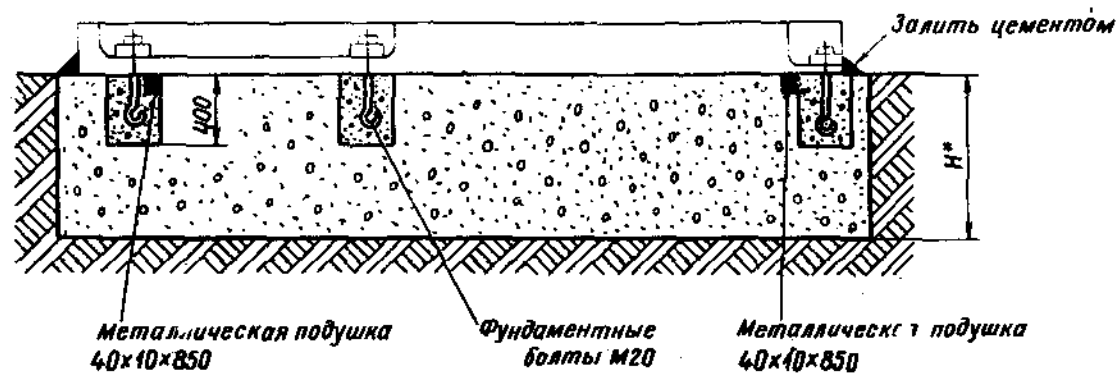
Стол. Поясодочные и присоединительные базы станка
